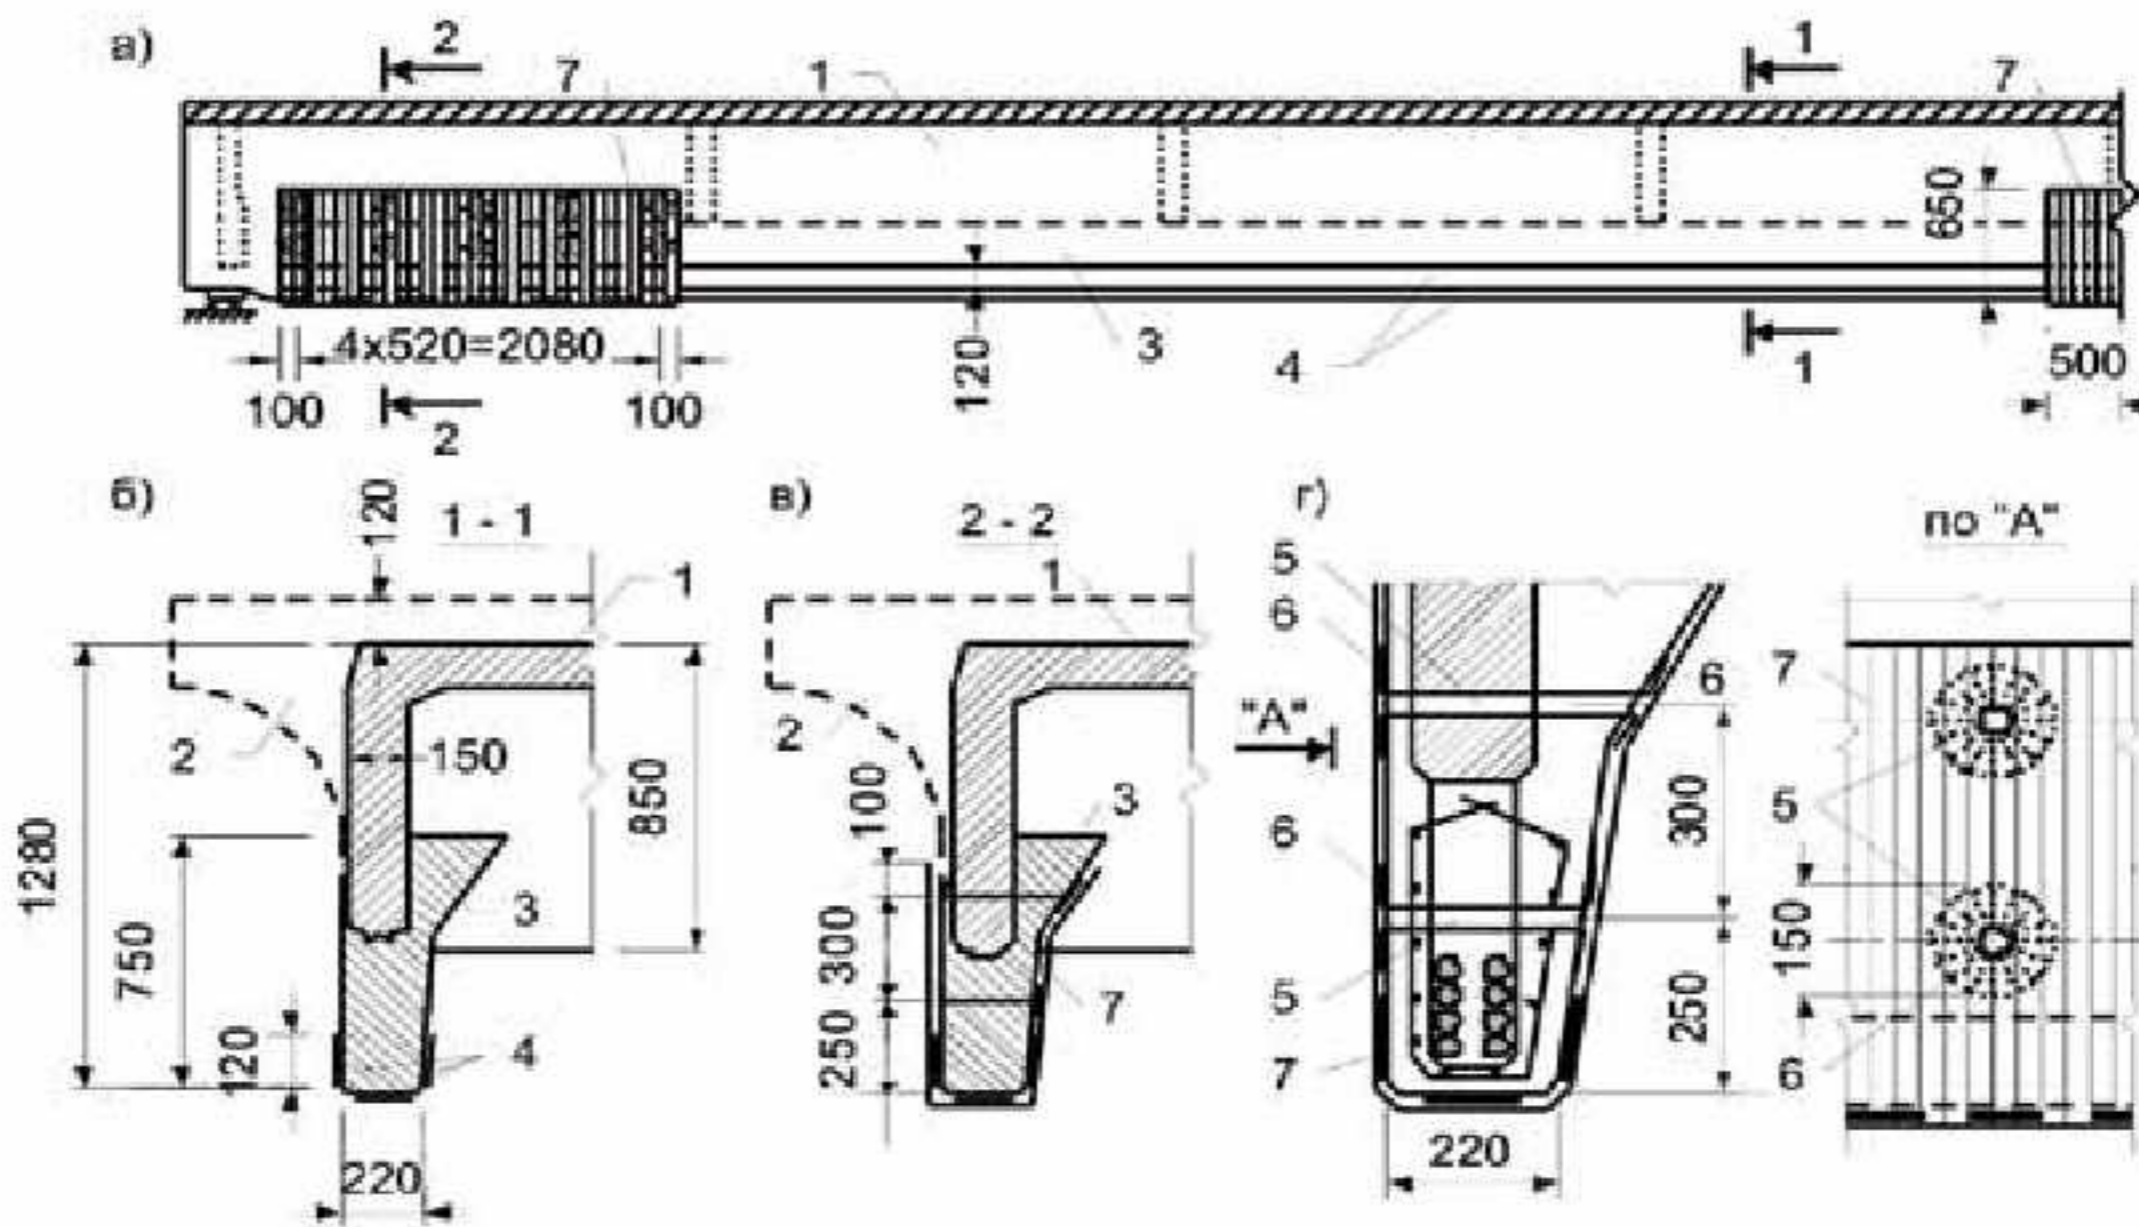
Ремонт і підсилення крайніх балок прольотної будови середнього прольоту приклеюванням стрічок CFRP: а - елементи підсилення балки; б, в - поперечні перерізи відремонтованої і підсиленої балки; г-деталь анкерування стрічок CFRP. 1-крайня балка; 2- монолітна залізобетонна накладна плита; 3-відновлення видаленого бетону повторним бетонуванням; 4-три стрічки CFRP типу M1214; 5-анкерні стержні; 6-наклеєні на поверхню балок розетки з полотна Wrap; 7-два шари полотна Wrap для анкерування стрічок
